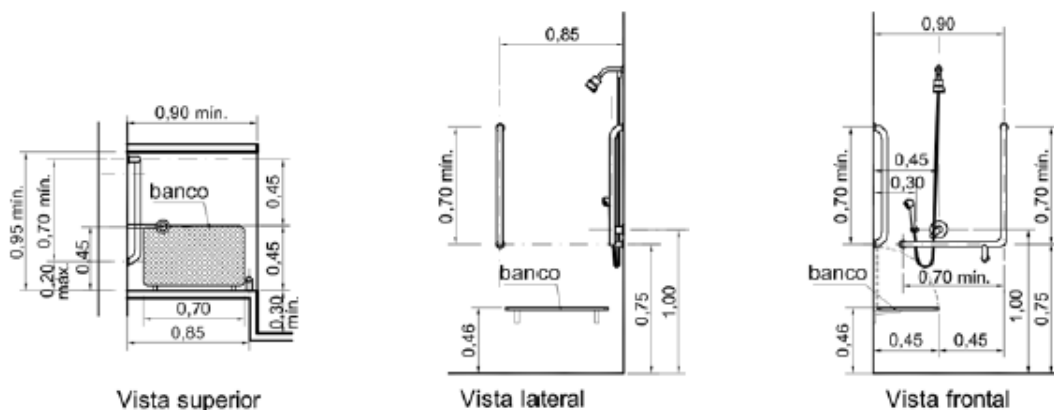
Boxe para chuveiro com barra de apoio em L - Exemplo
